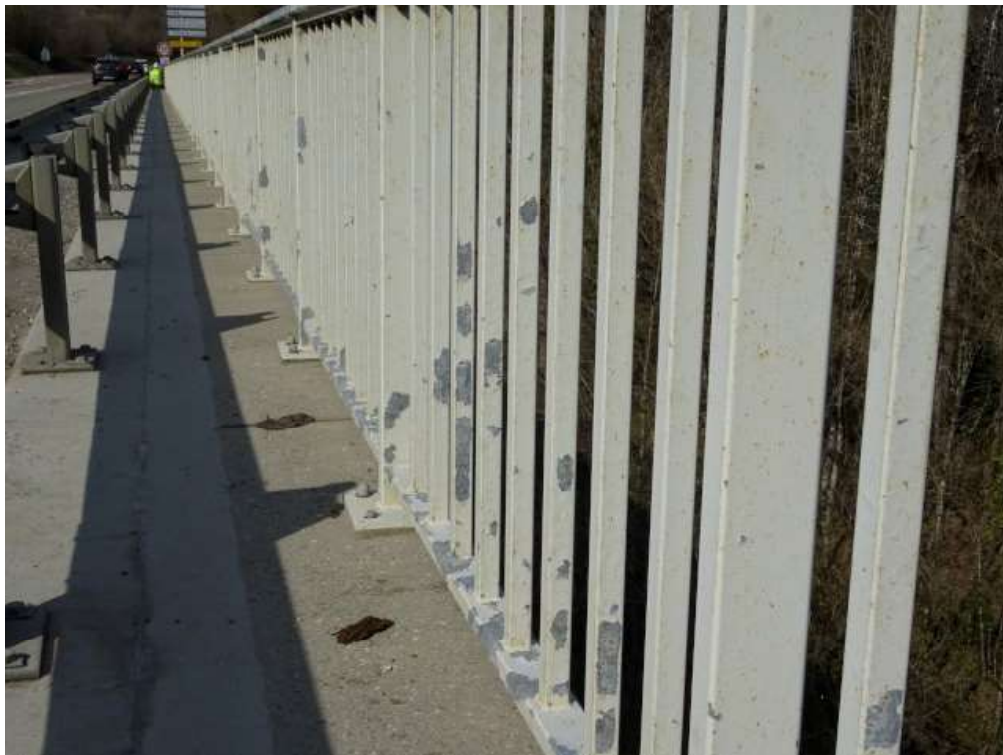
Garde-corps amont. Écaillage de la peinture et piqûres de rouille sur les montants entre S40-S41.
